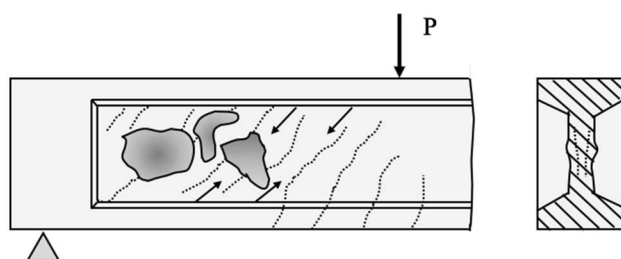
Rottura delle diagonali compresse di una sezione trasversale ad I con forte armatura, cedimento improvviso del calcestruzzo dell'anima (rielaborato da Fib Bulletin 57)
